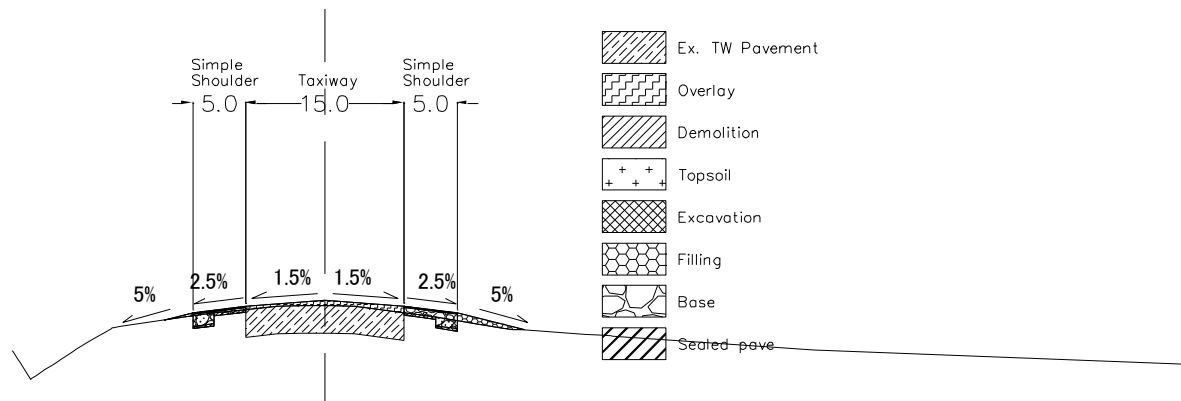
TW-A 標準横断面図 Sta. 6+53.668
